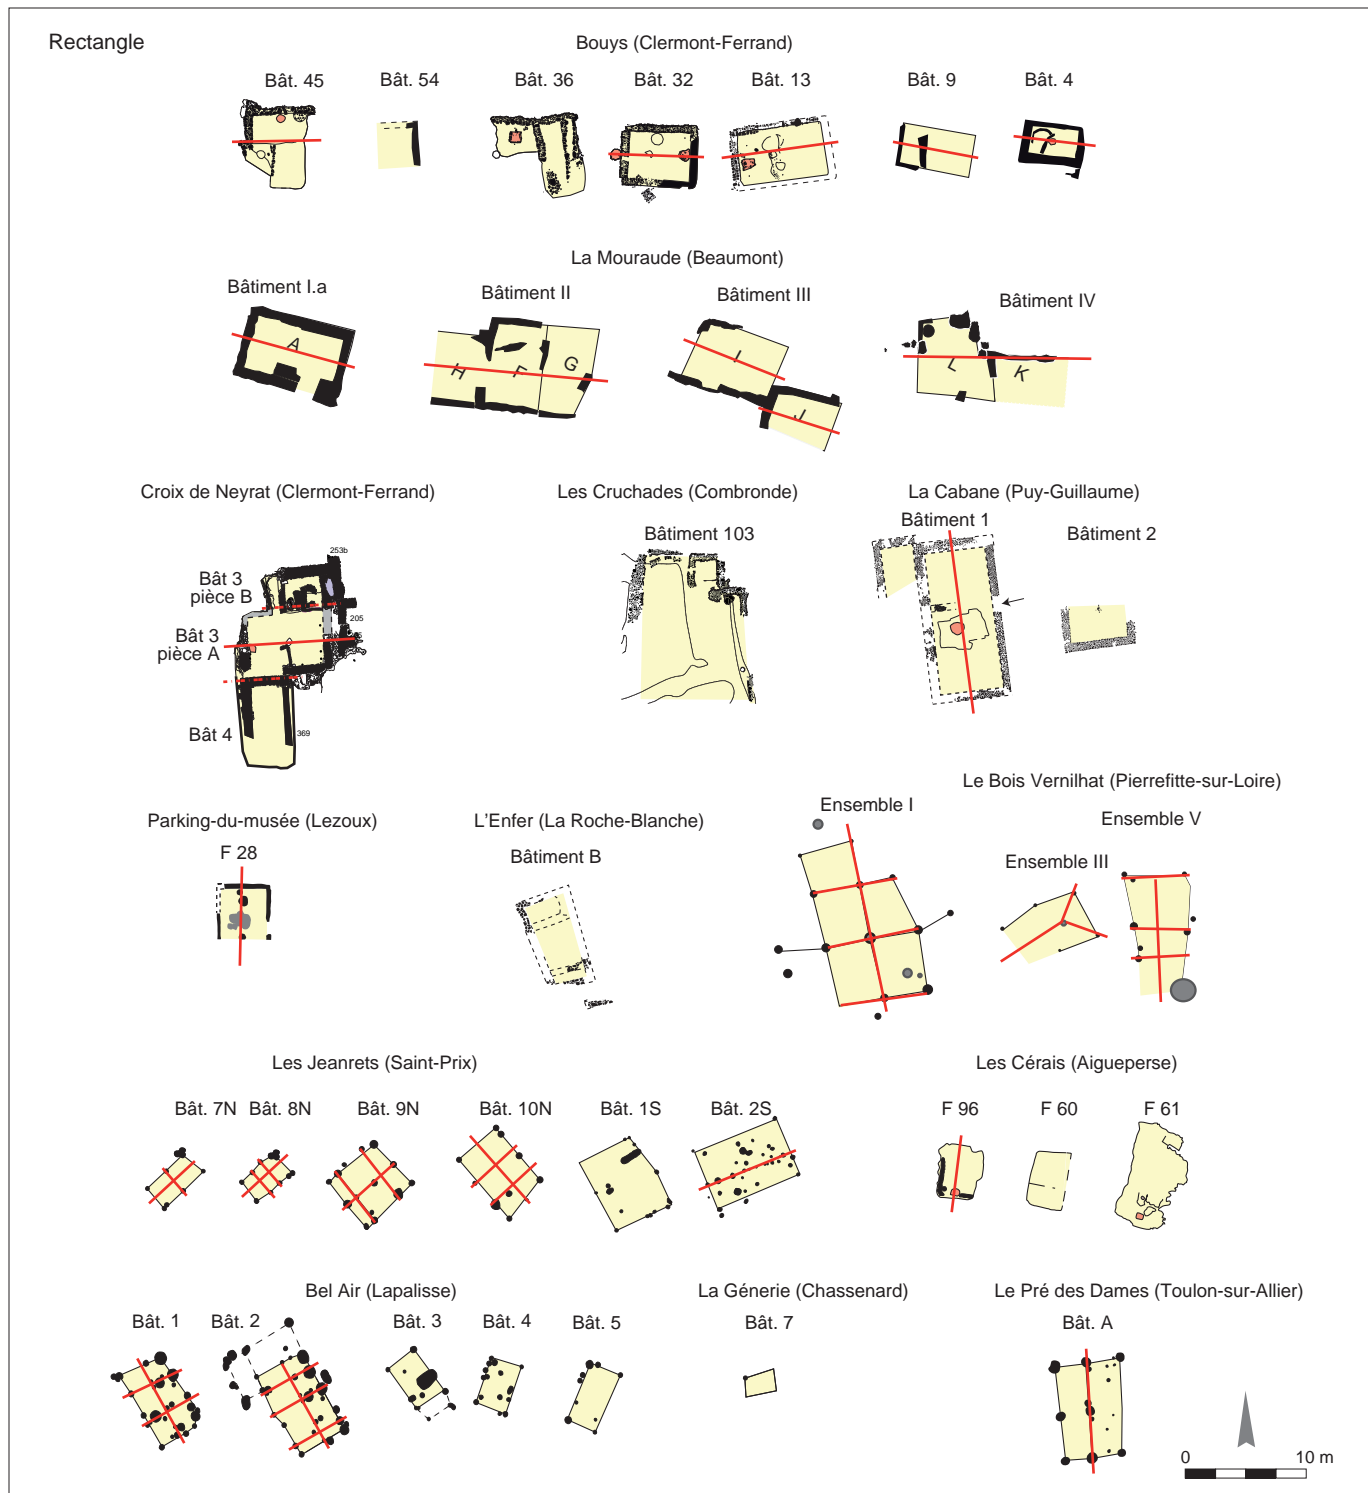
Plan des bâtiments: plan au sol et schéma de toiture selon les axes faîtières en rouge. © S. Gaime, D. Parent.
